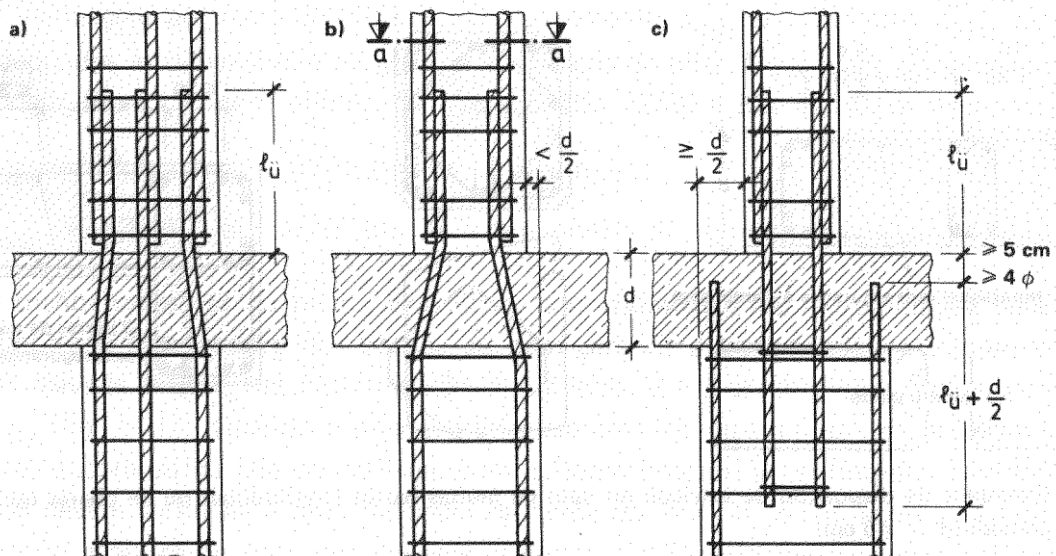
Detalhe dos transpasses das armaduras de pilares
